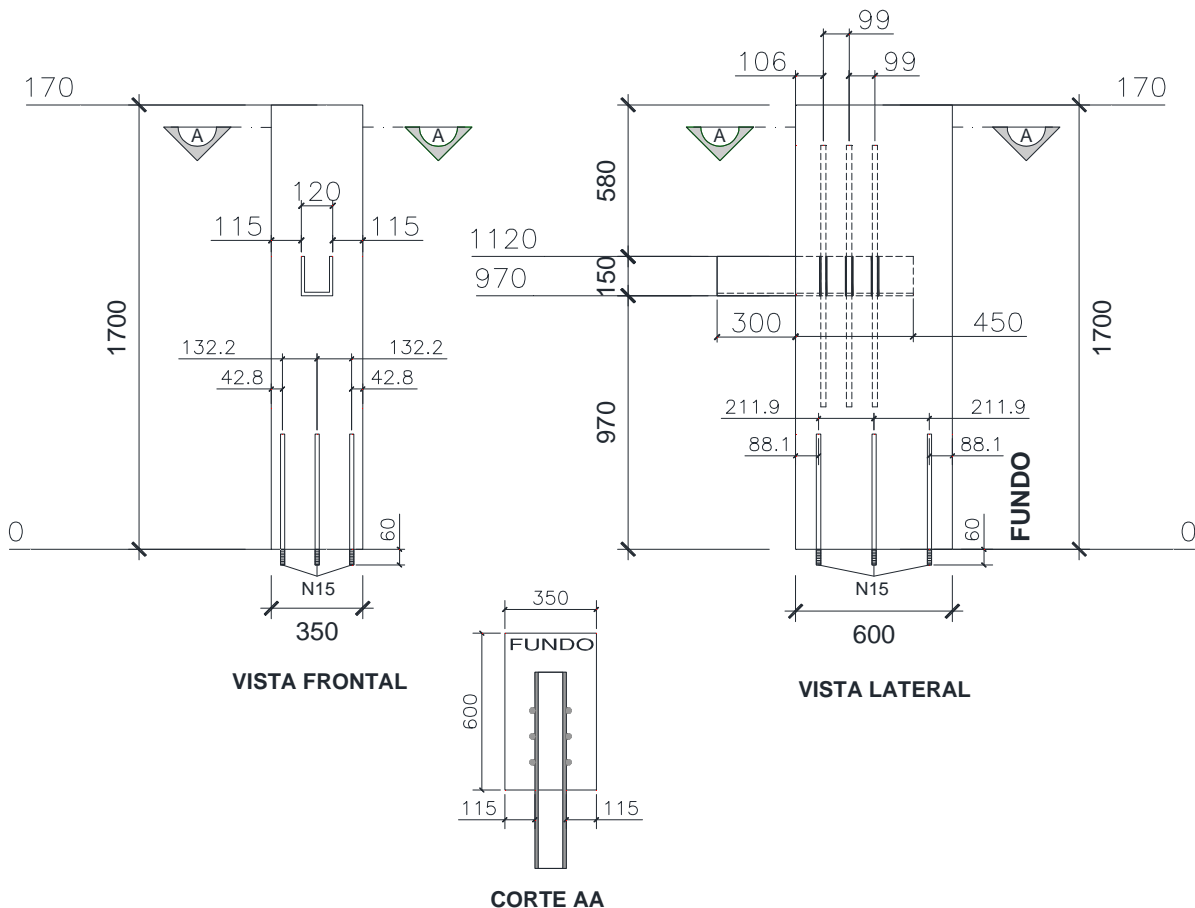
Dimensões do pilar pré-moldado tipo A (consolo-12,5).
